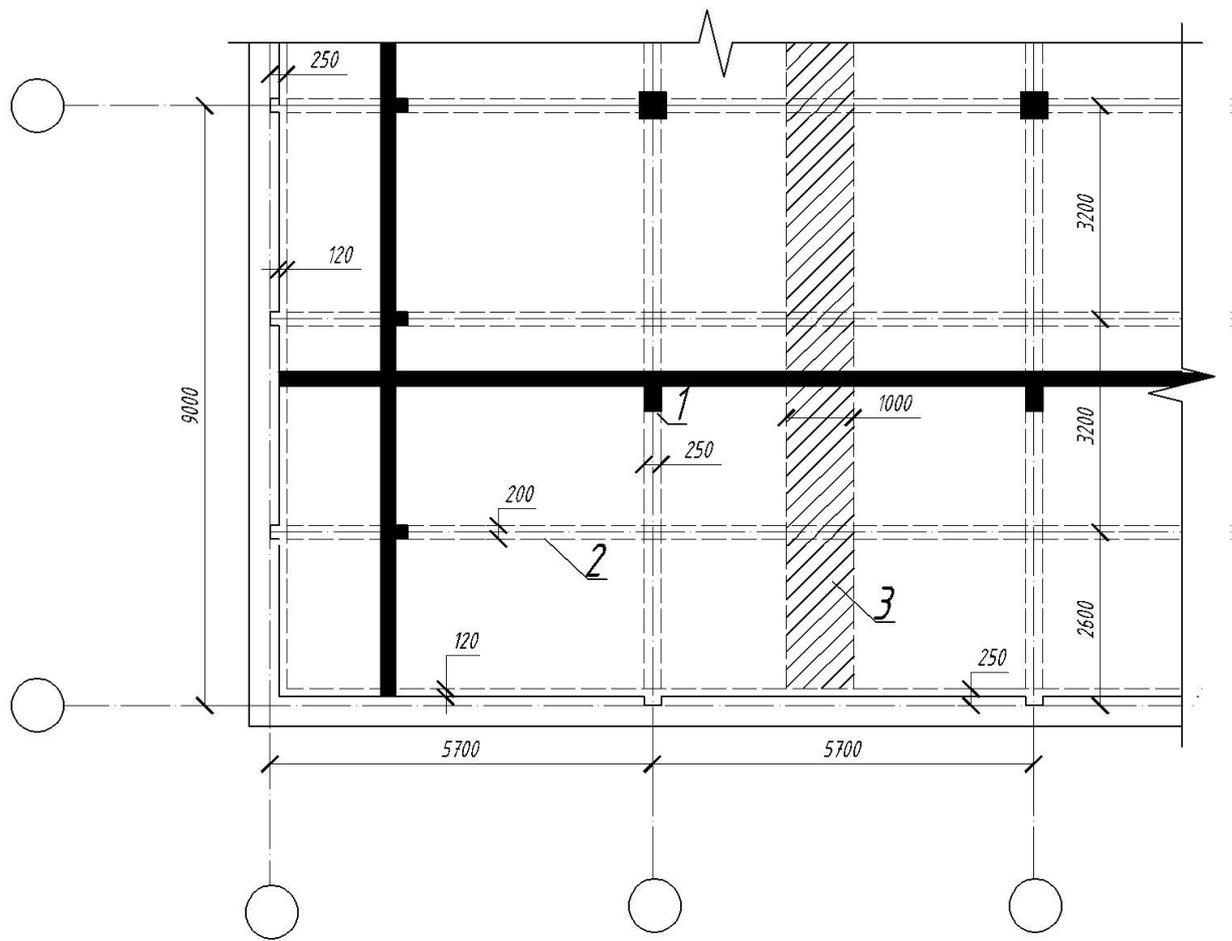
Конструктивная схема монолитного ребристого перекрытия
